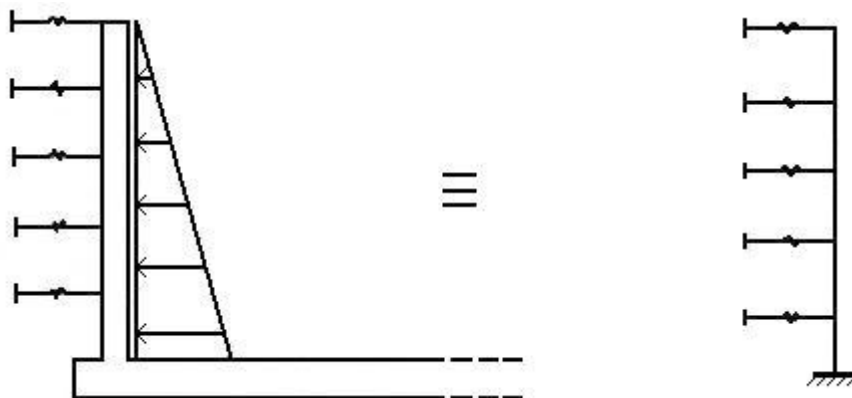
Modelo estrutural baseado na união monolítica parede – laje de fundação.
